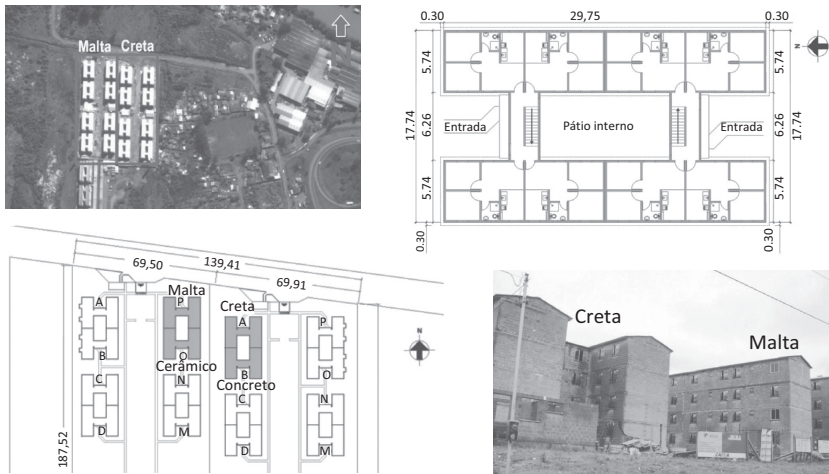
Disposição das edificações em alvenaria de blocos de concreto e cerâmico.
